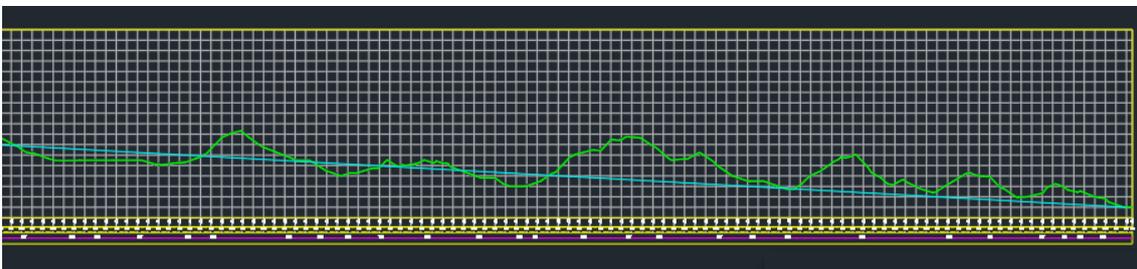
Perfil Longitudinal via existente com inclinação do relevo 2/2 (Autoria Própria)
